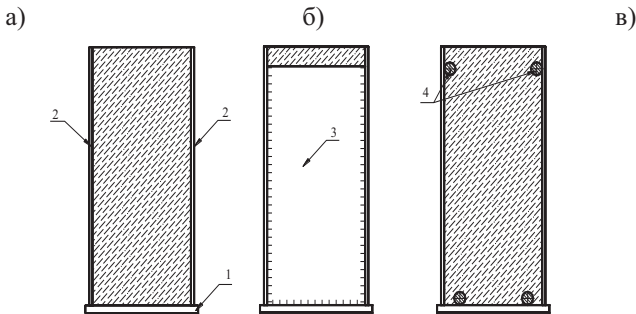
Схеми запропонованих поперечних перерізів сталезалізобетонних балок із зовнішнім листовим армуванням:
